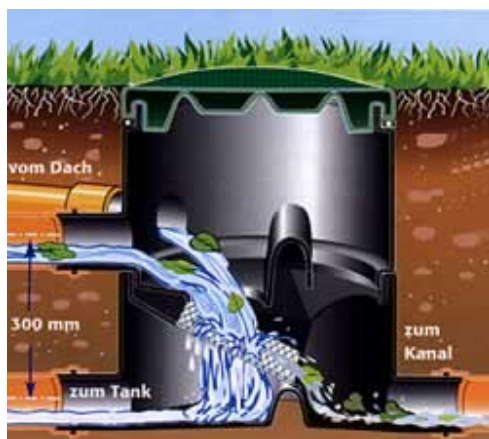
Filtro para retenção de materiais sólidos proveniente do telhado
